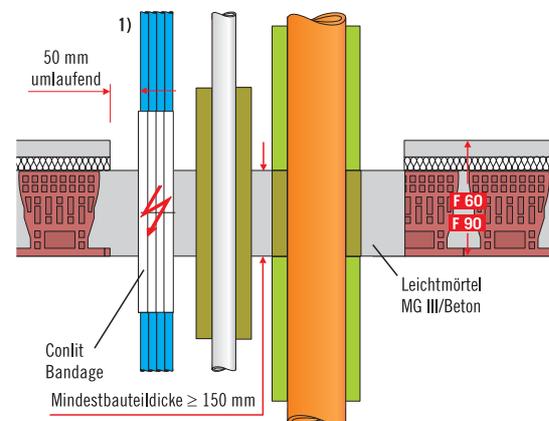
Beispiel zur Abschottung einer Rippen-/Ziegeldecke mit Leichtmörtel MG III/Beton
